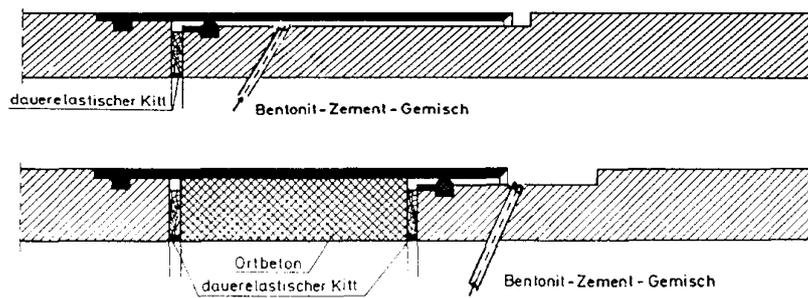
Zwischenpressstationen nach der Demontage [18]
